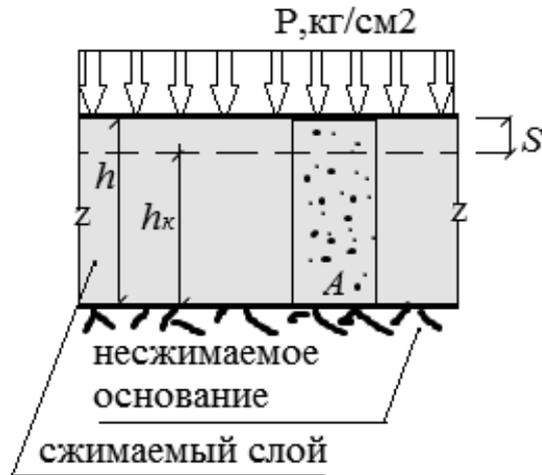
Схема сжатия слоя при сплошной нагрузке: h – начальная высота образца; h_k – конечная высота образца; A – площадь поперечного сечения цилиндра грунта; S – осадка слоя
